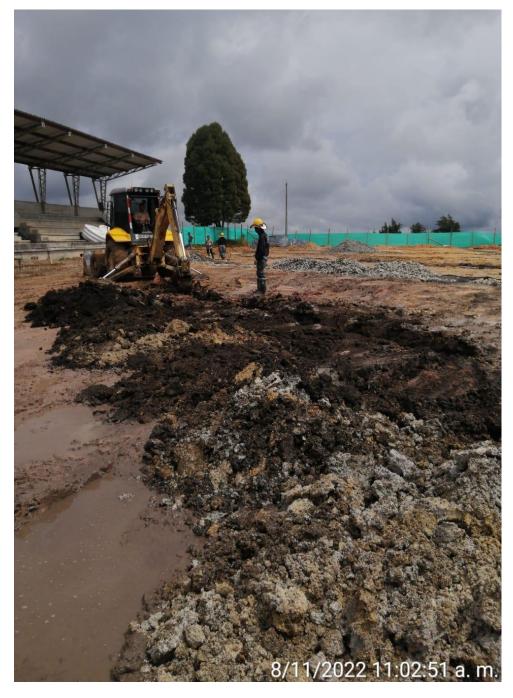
Conformación de tramo de filtro. Se observa el material encontrado durante las excavaciones
